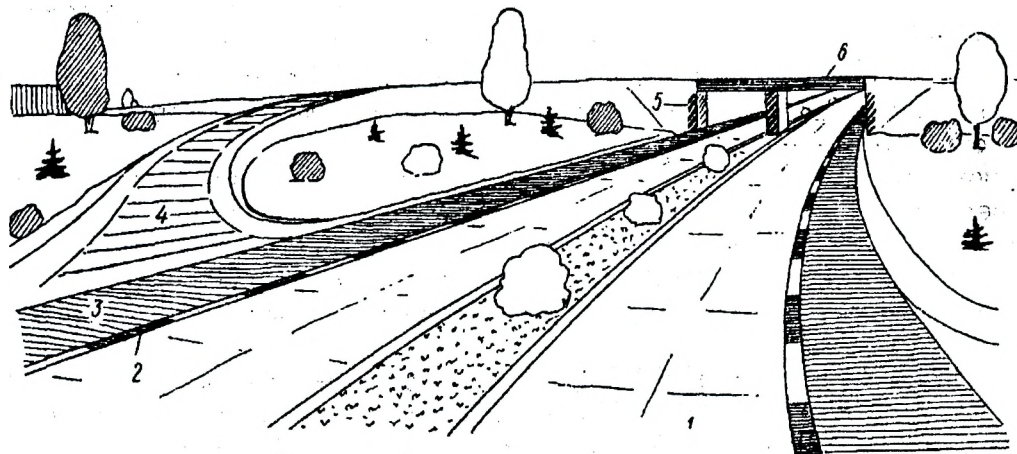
Схема цветового оформления пересечений в разных уровнях: 1 – серое цементобетонное покрытие; 2 – краевая полоса из темного и белого бетона; 3 – асфальтобетонная переходно-скоростная полоса; 4 – левоповоротная полоса из мозаики; 5 – окраска опор моста черными полосами; 6 – окраска балки красными полосами
